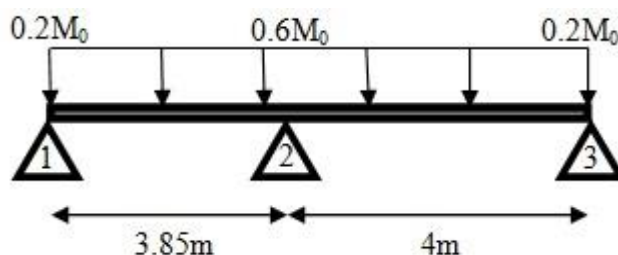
Schéma statique de poutrelle (3<sup>ème</sup> type terrasse).
